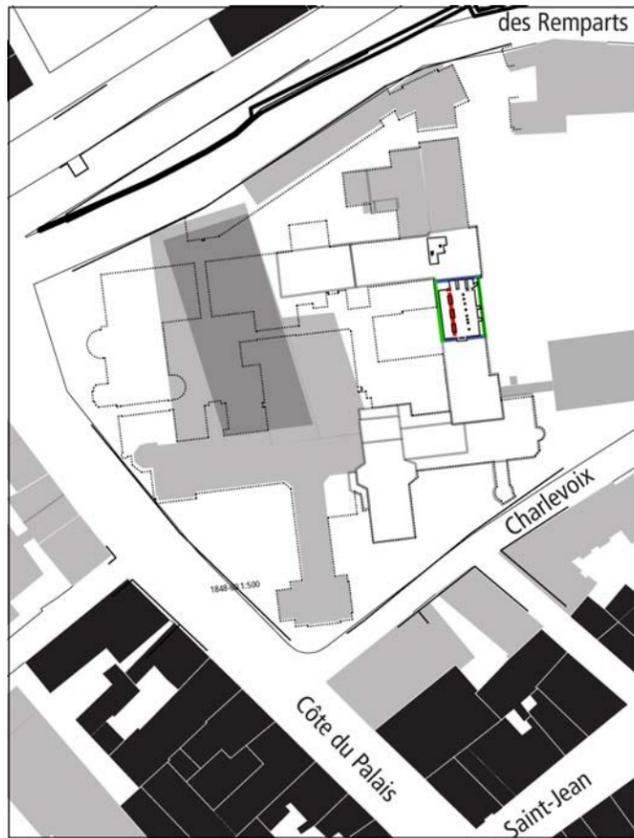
Composition structurale des murs porteurs, 1953, étage des fondations (niveau 00)
